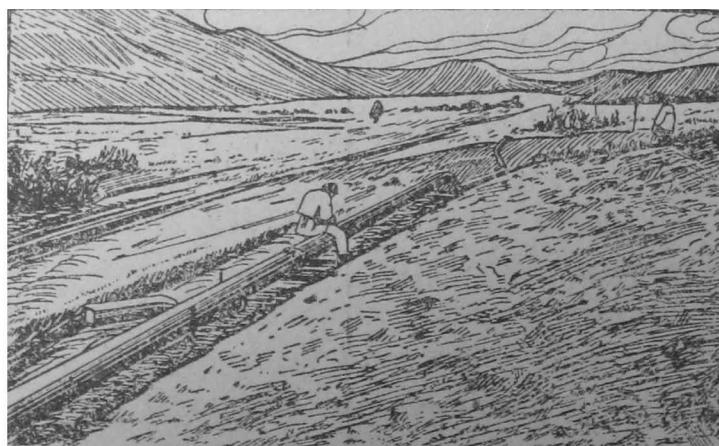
Нефтепровод Баку—Батум. Сварка труб.
